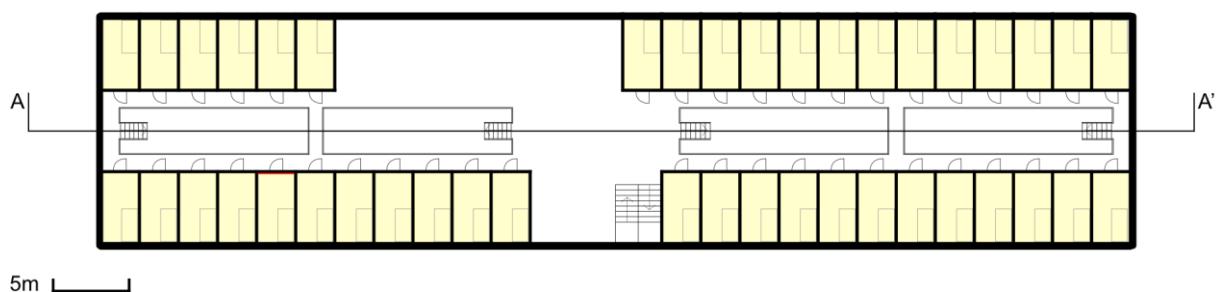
Plan du 2^{ème} étage du bâtiment 4a
